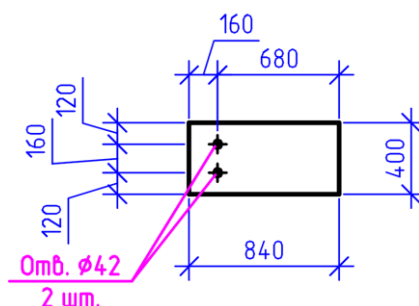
Фасонка, для болтового соединения элемента связей по верхнему поясу ферм
